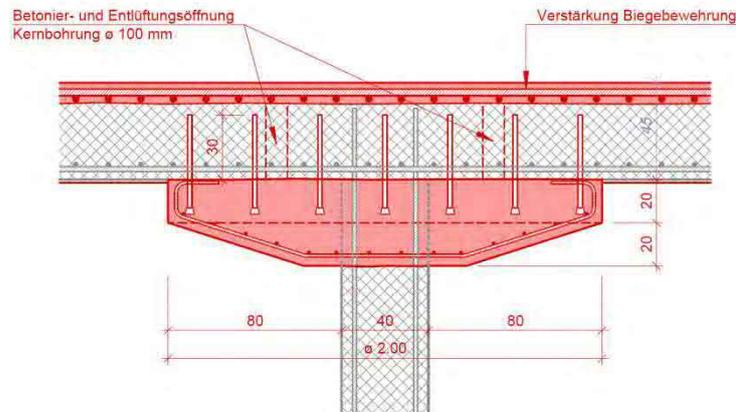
Durchstanzverstärkung mittels Betonpilz gemäss Auflageprojekt Neubau Schulhausplatz
